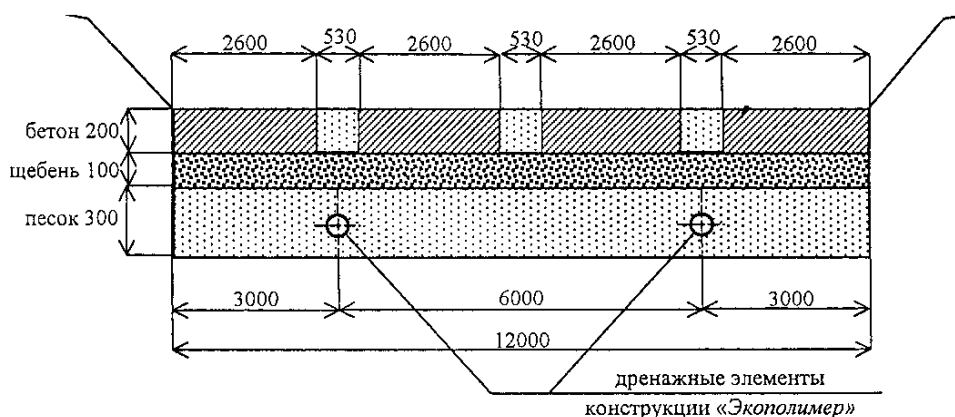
Конструкция дренажа иловых площадок. Пластовый дренаж
